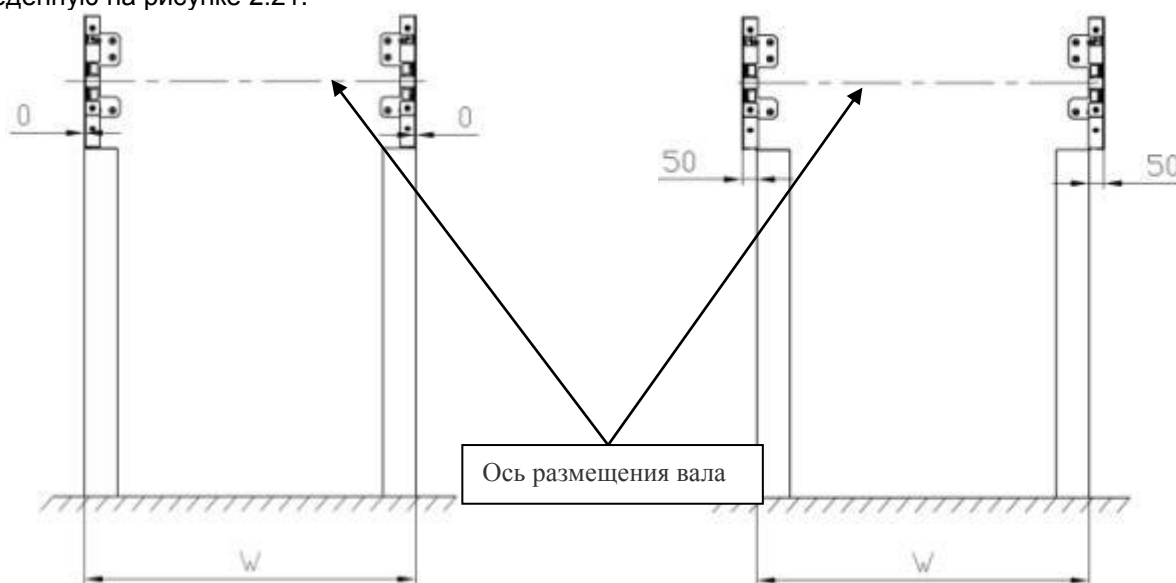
Установка консоли ССМ в крышке SF405/C
